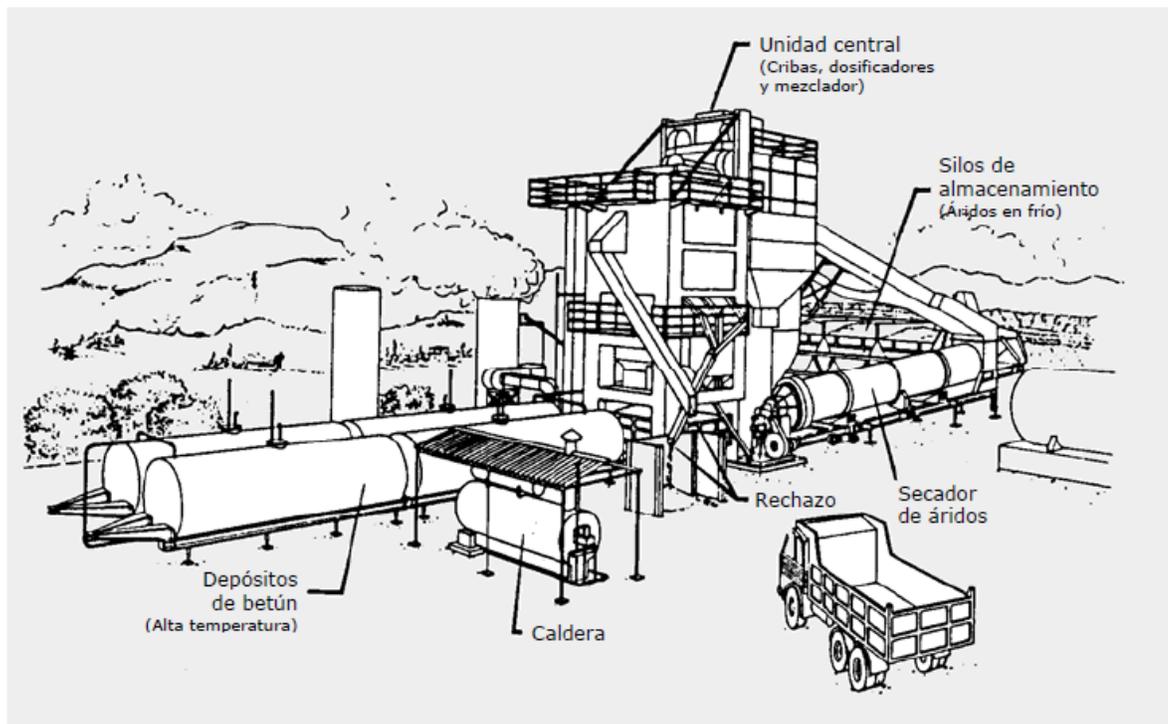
Esquema general de una planta central de fabricación de Mezcla⁵⁷
